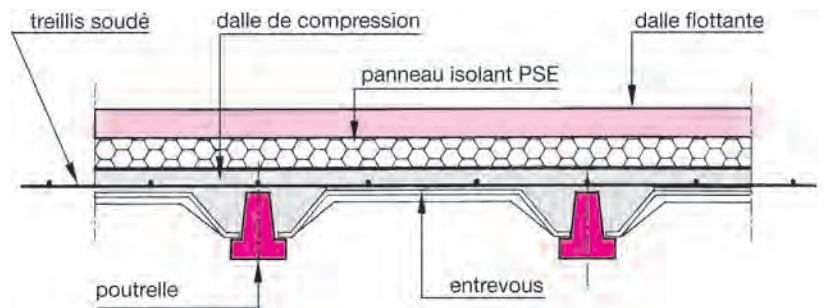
Plancher avec poutrelles précontraintes et entrevous en bois moulé
